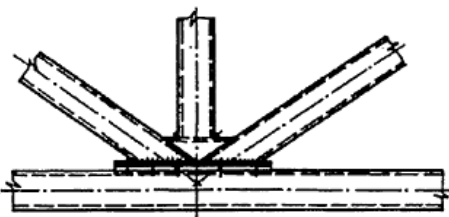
Узел фермы с отсоединяющимся нижним поясом
